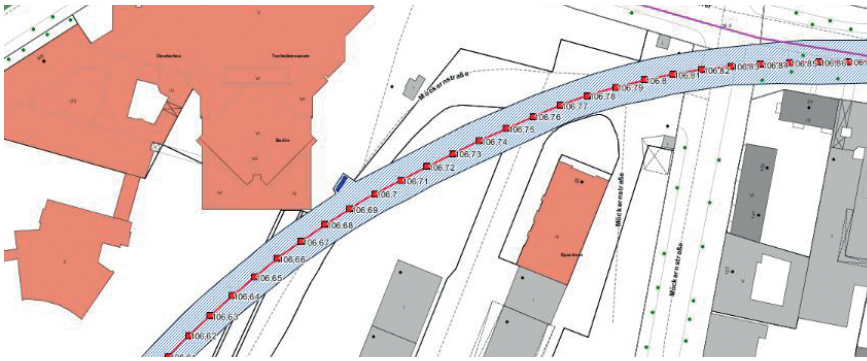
Höhenlange U-Bahntrasse, Plan der BVG
